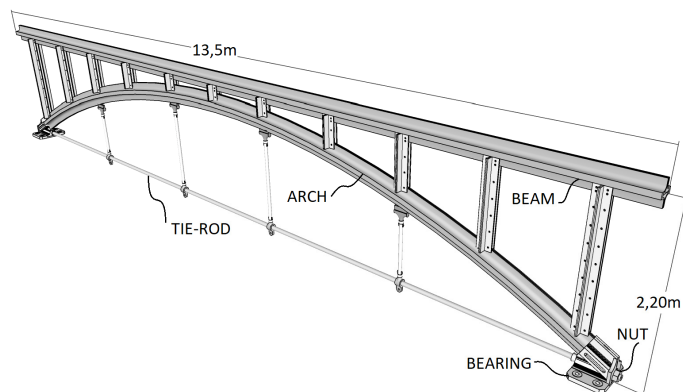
; DESENHO ORIGINAL - VISTA LONGITUDINAL [4]
